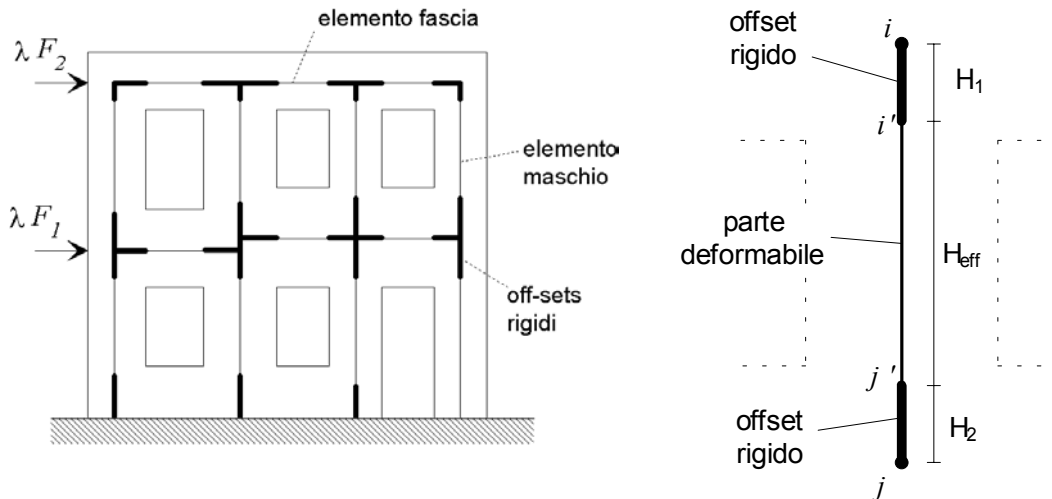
Schematizzazione a telaio equivalente di una parete caricata nel piano e individuazione delle porzioni rigide
